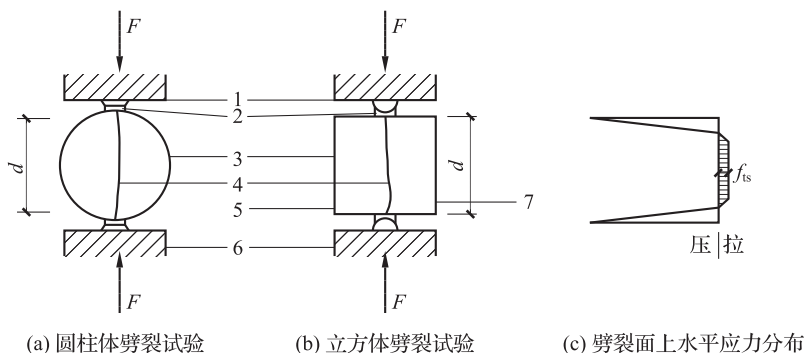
劈裂试验测试混凝土轴心抗拉强度
